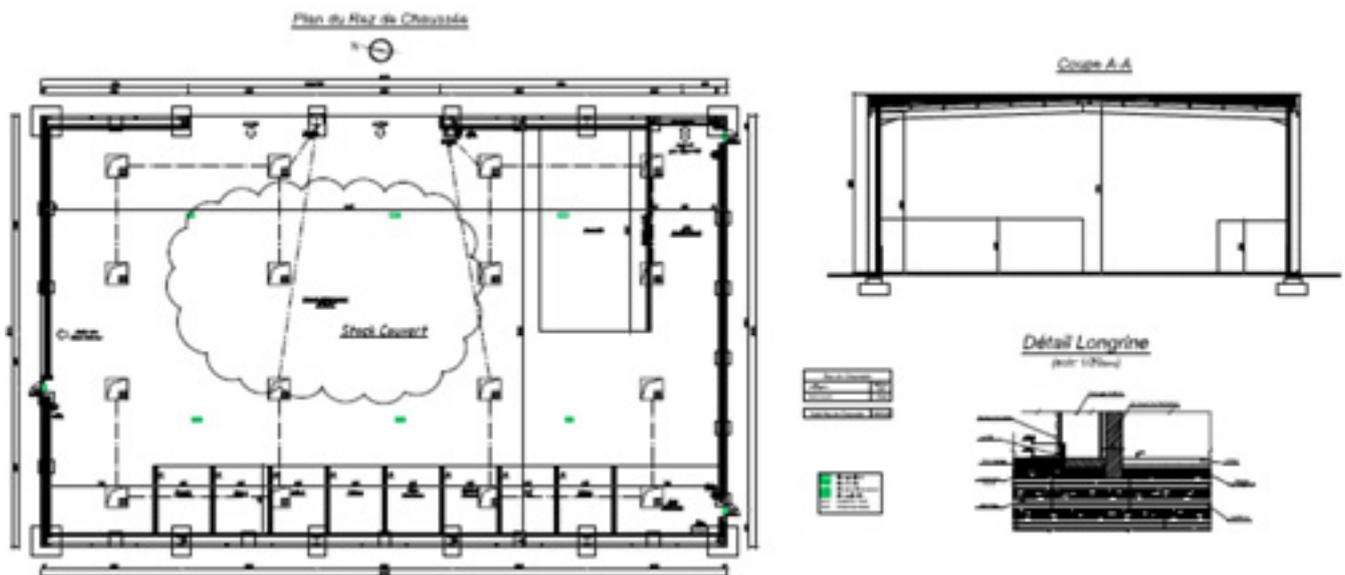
Plan de masse du bâtiment de tri – Chavigny Recyclage
